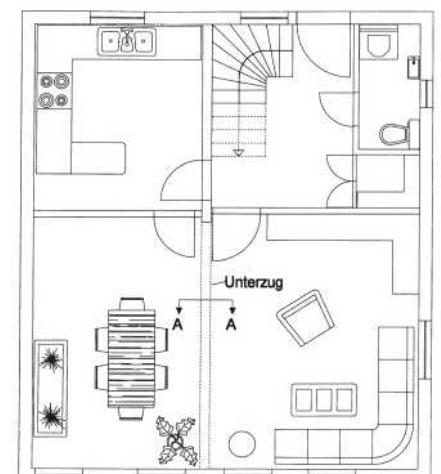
Beispiel - Grundriß zur Darstellung eines fiktiven Brandes
